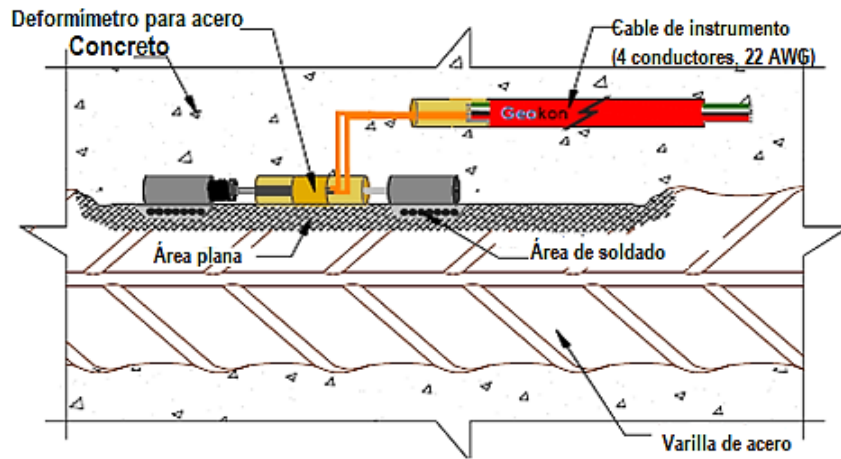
Deformímetros para acero instalados (GEOKON, 2018)
